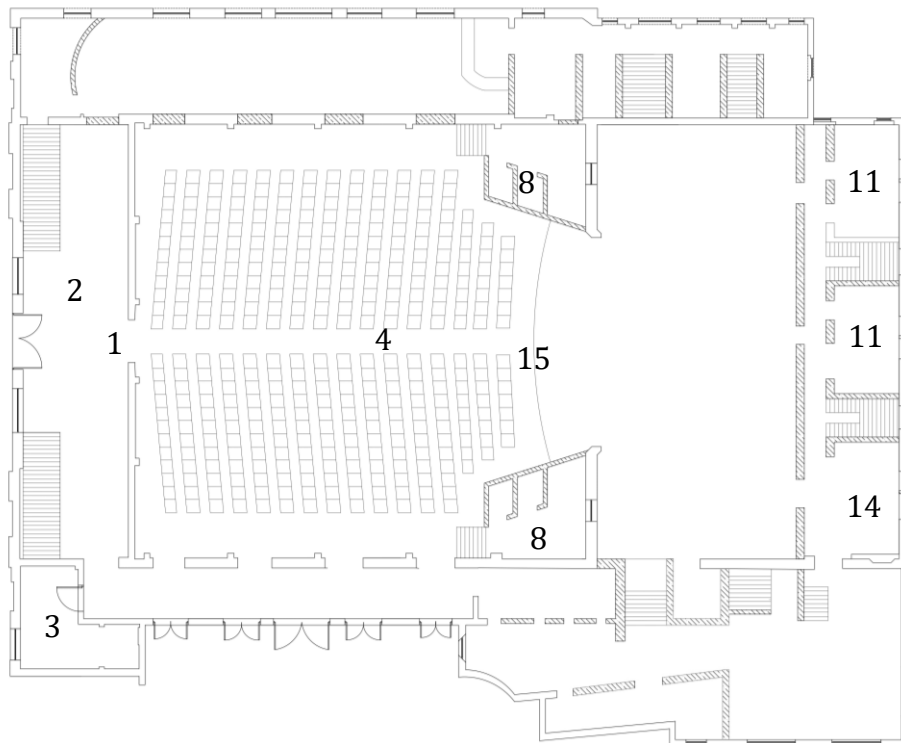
Planta original, Piso 0, Fonte: Autor
